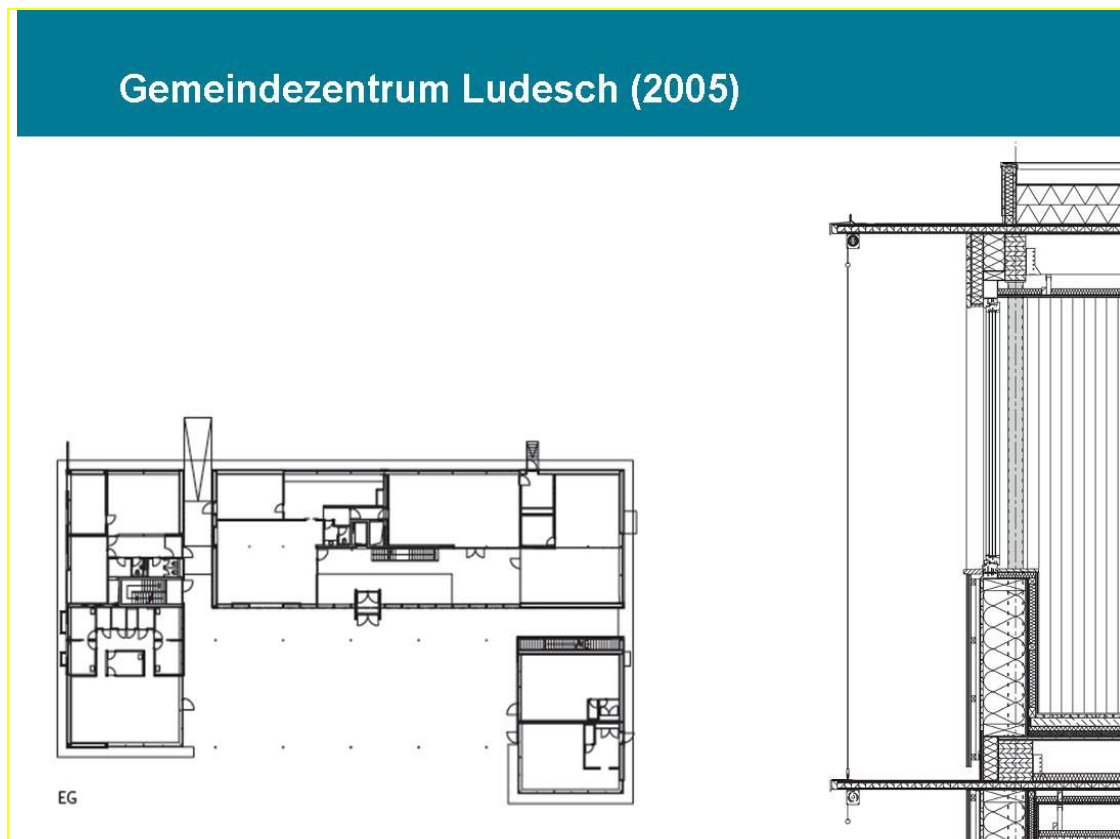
Gemeindeforum Ludesch Grundriss EG, Detailschnitt
